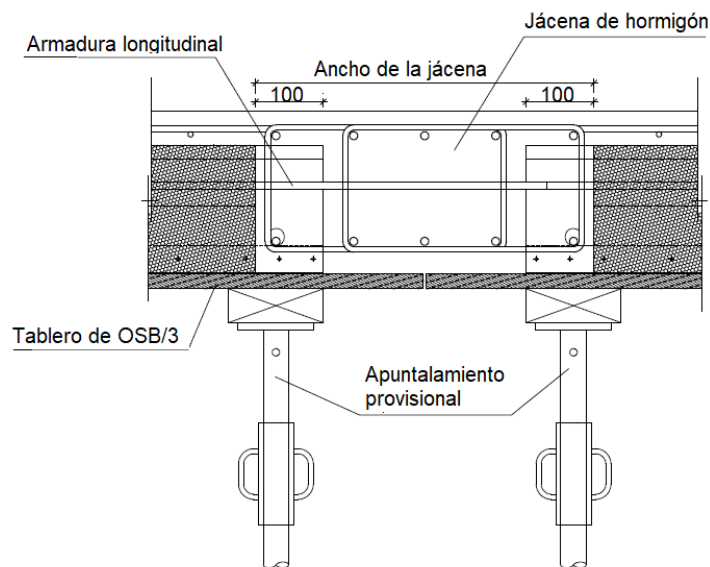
Apoyo frontal de forjado con el sistema SES™ sobre jácena plana de hormigón con perfil abierto.
